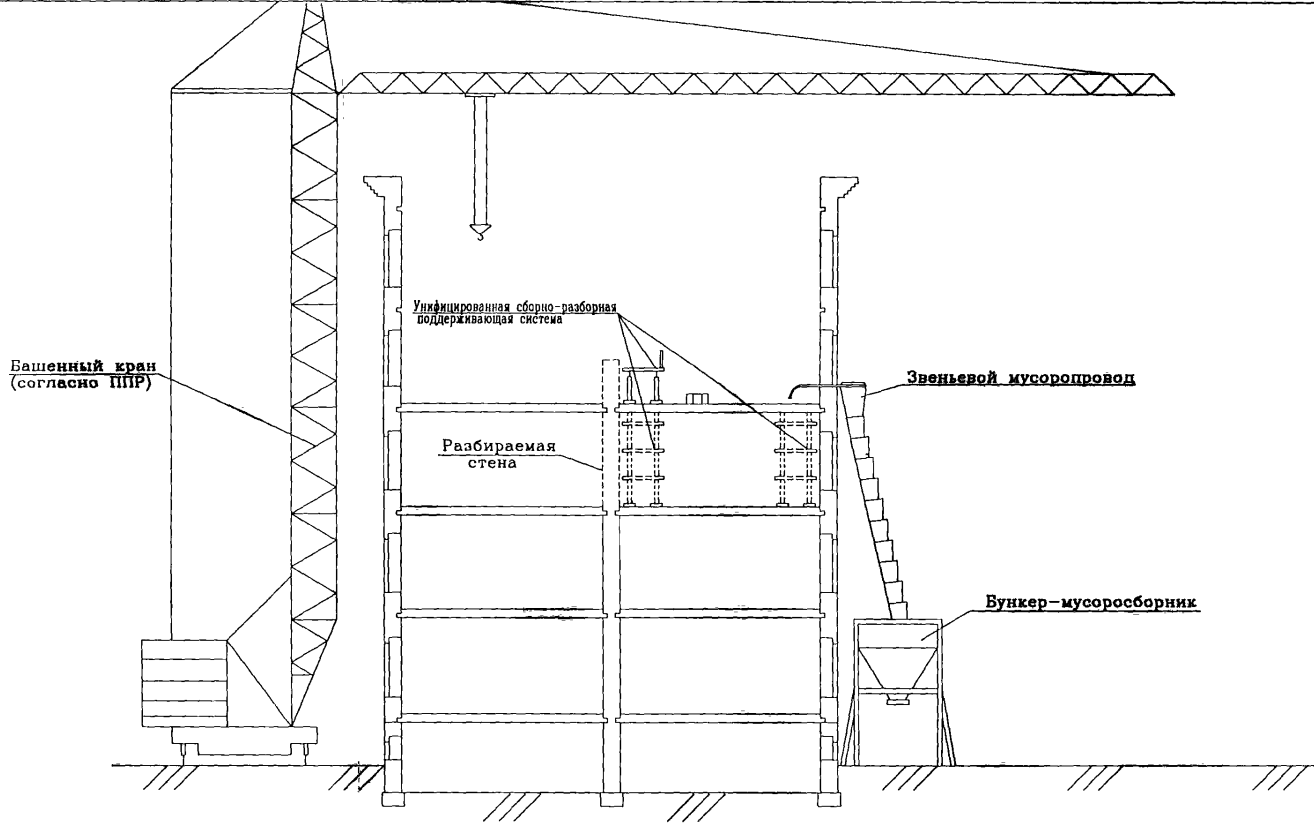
Общая схема организации работ по разборке внутренних стен с разборкой перекрытий
